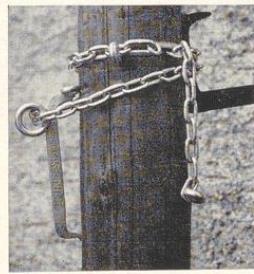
Befestigung der Stellstange am Mauerhaken mit dem Kettenspanner
